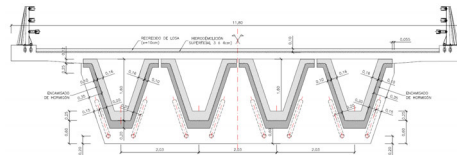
Sección transversal del tablero con refuerzo de postesado y encamisado de hormigón
